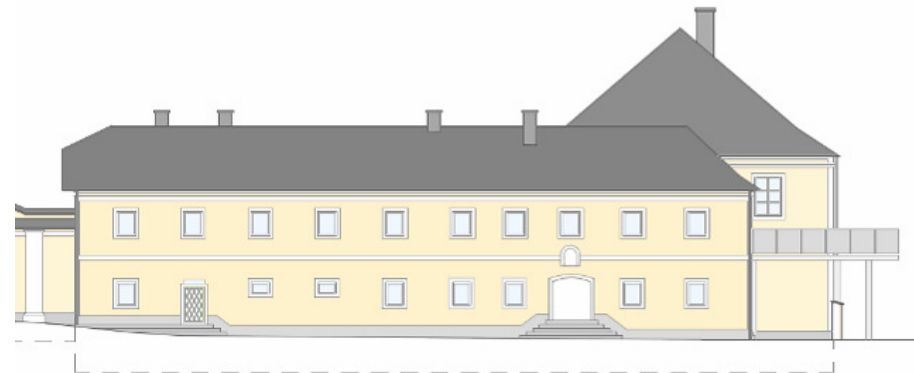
Nordost Fassade Entwurf. Der Durchgang zwischen Kirche und Pfarrhof ist nun geöffnet. Außerdem zieren vergrößerte Fensteröffnungen die Fassade. Die Gitter wurden entfernt.
